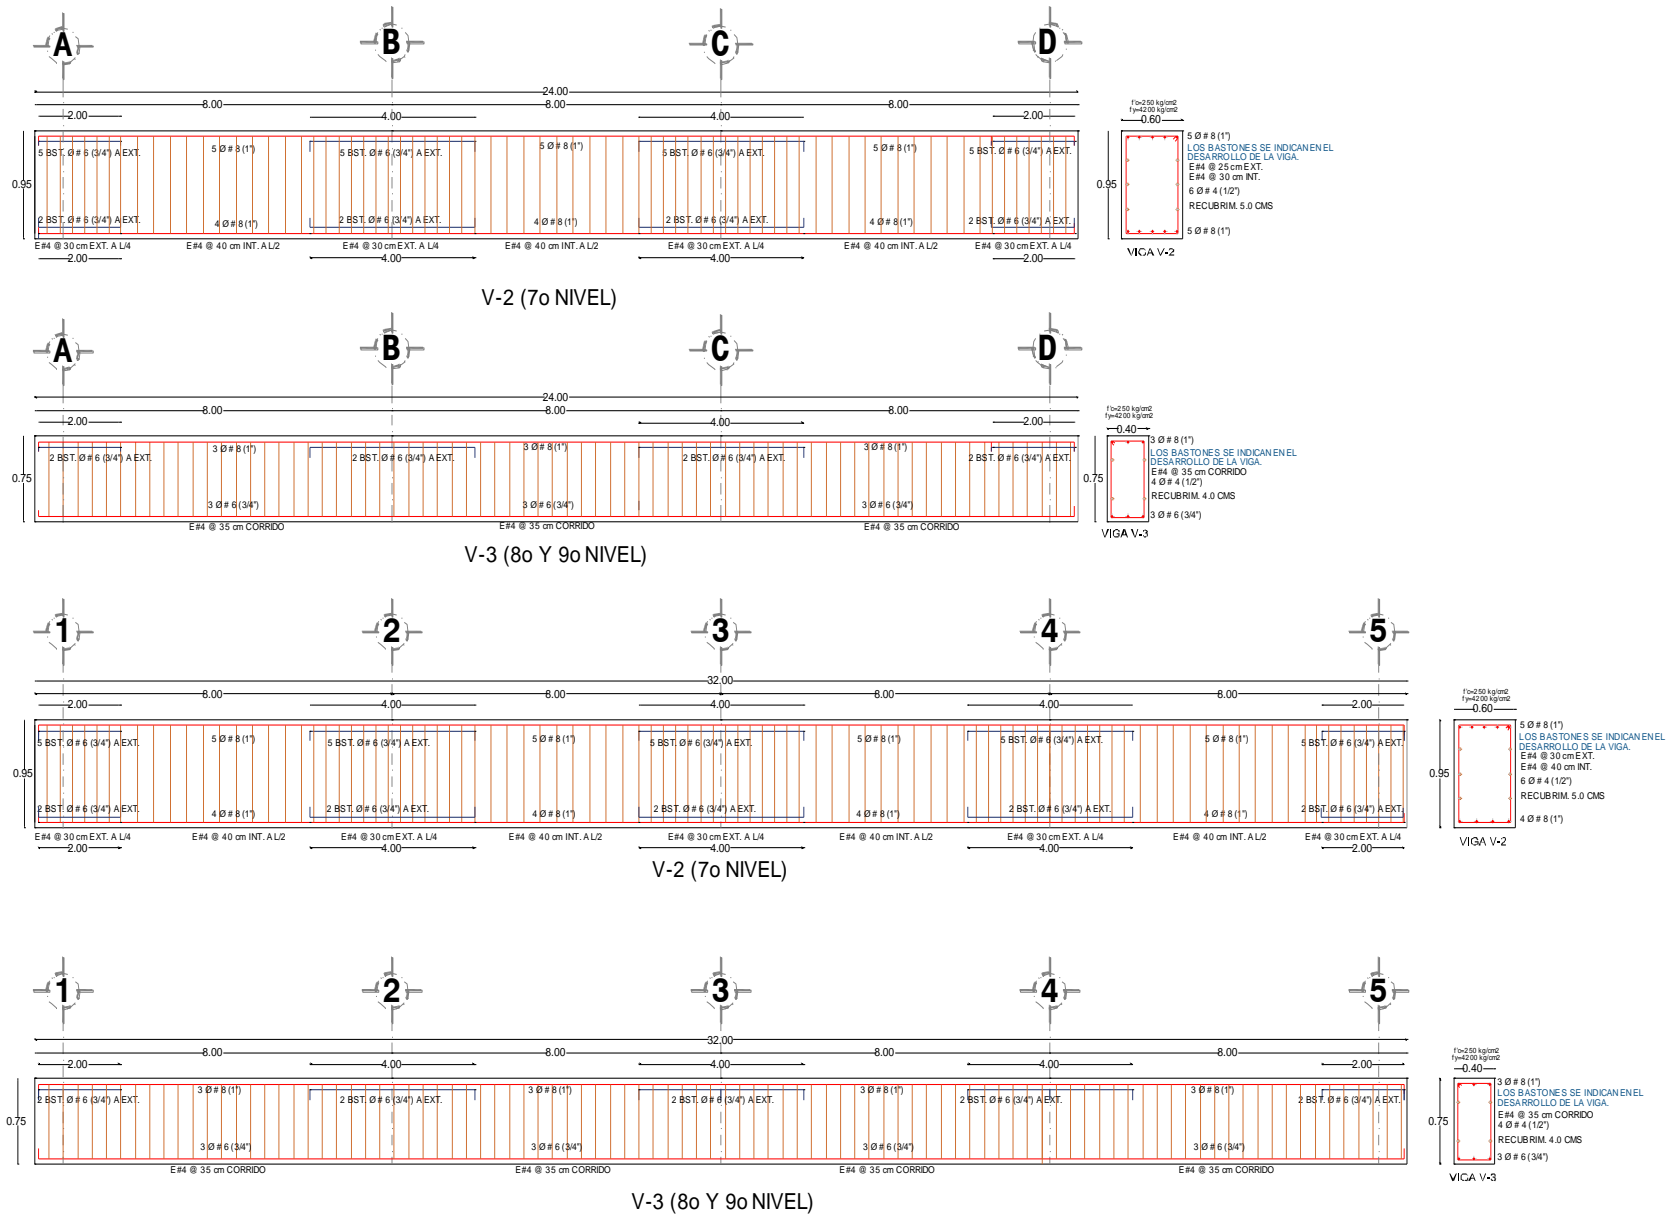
Detallado de armado de vigas de edificio de 9 niveles con base a la hipótesis de las NTCC-04 (continuación).
